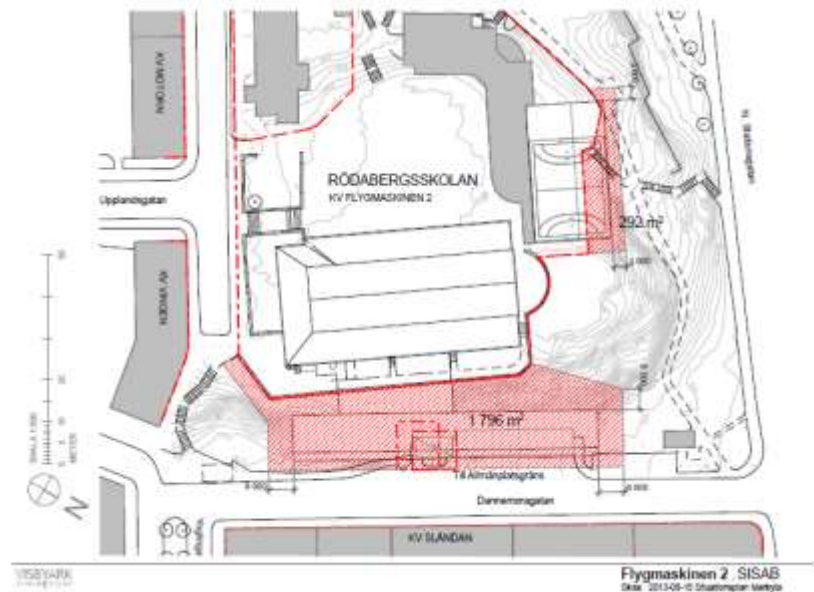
Tillbyggnadernas placering i stadsbilden.
